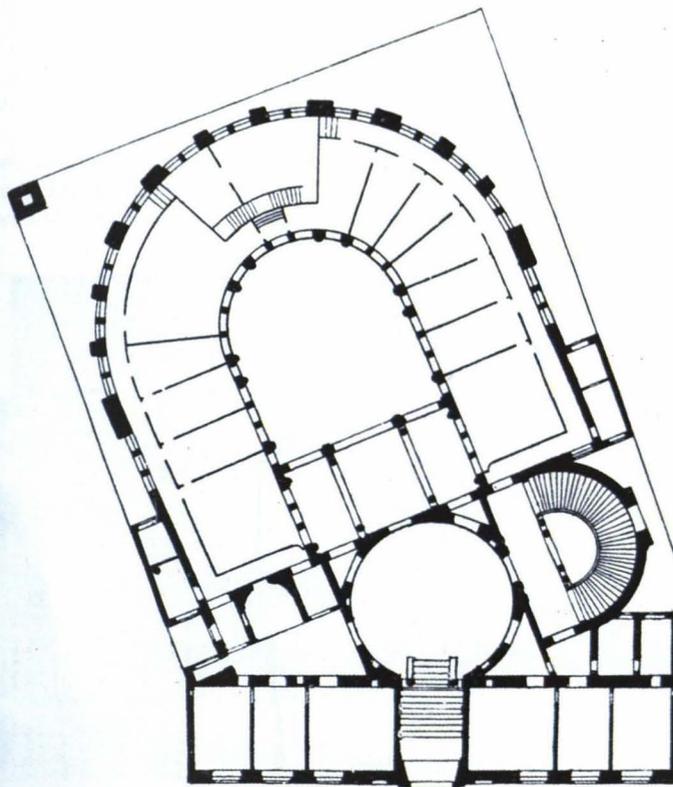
Otto Wagner, Plan der Österreichische Länderbank, 1882, Grundriss
